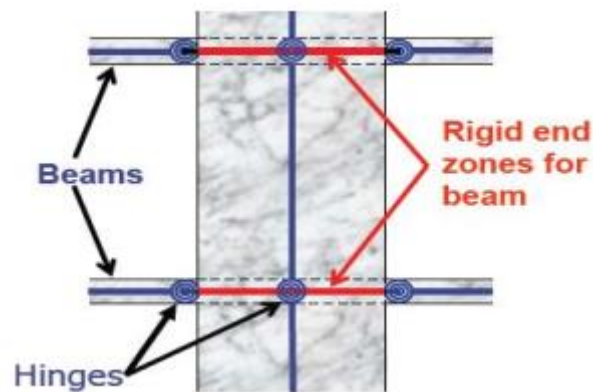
Modèle “ Poteau-Poutre équivalent”.
